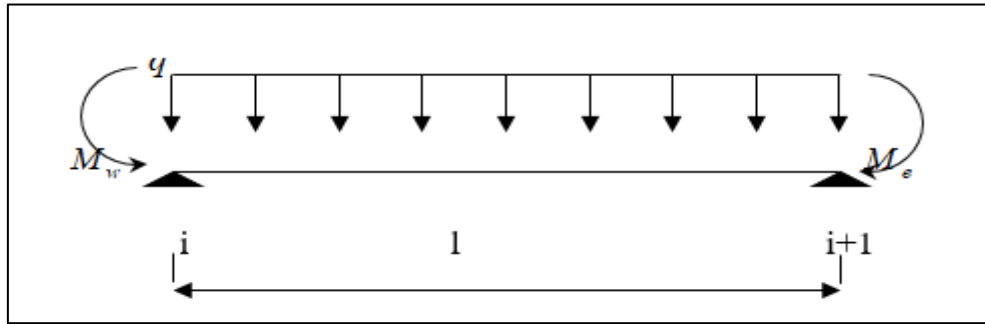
Schéma de calcul d'une poutrelle simplement appuyée
